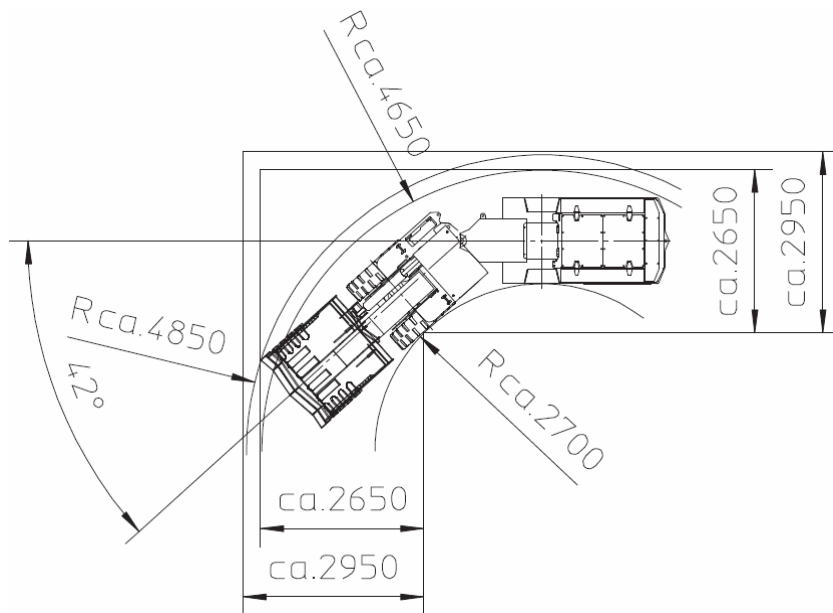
PFL 12 en vista planta, radio de giro
